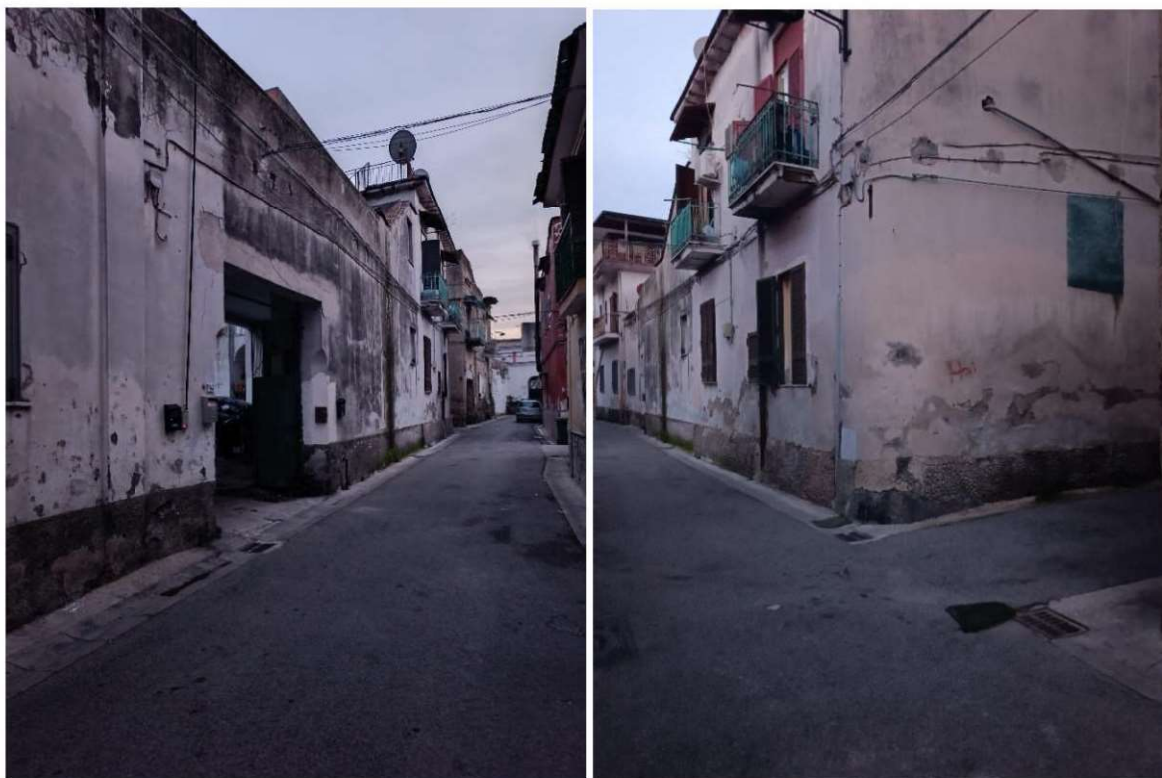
Foto 2: Ingresso palazzo – Prospetto esterno
